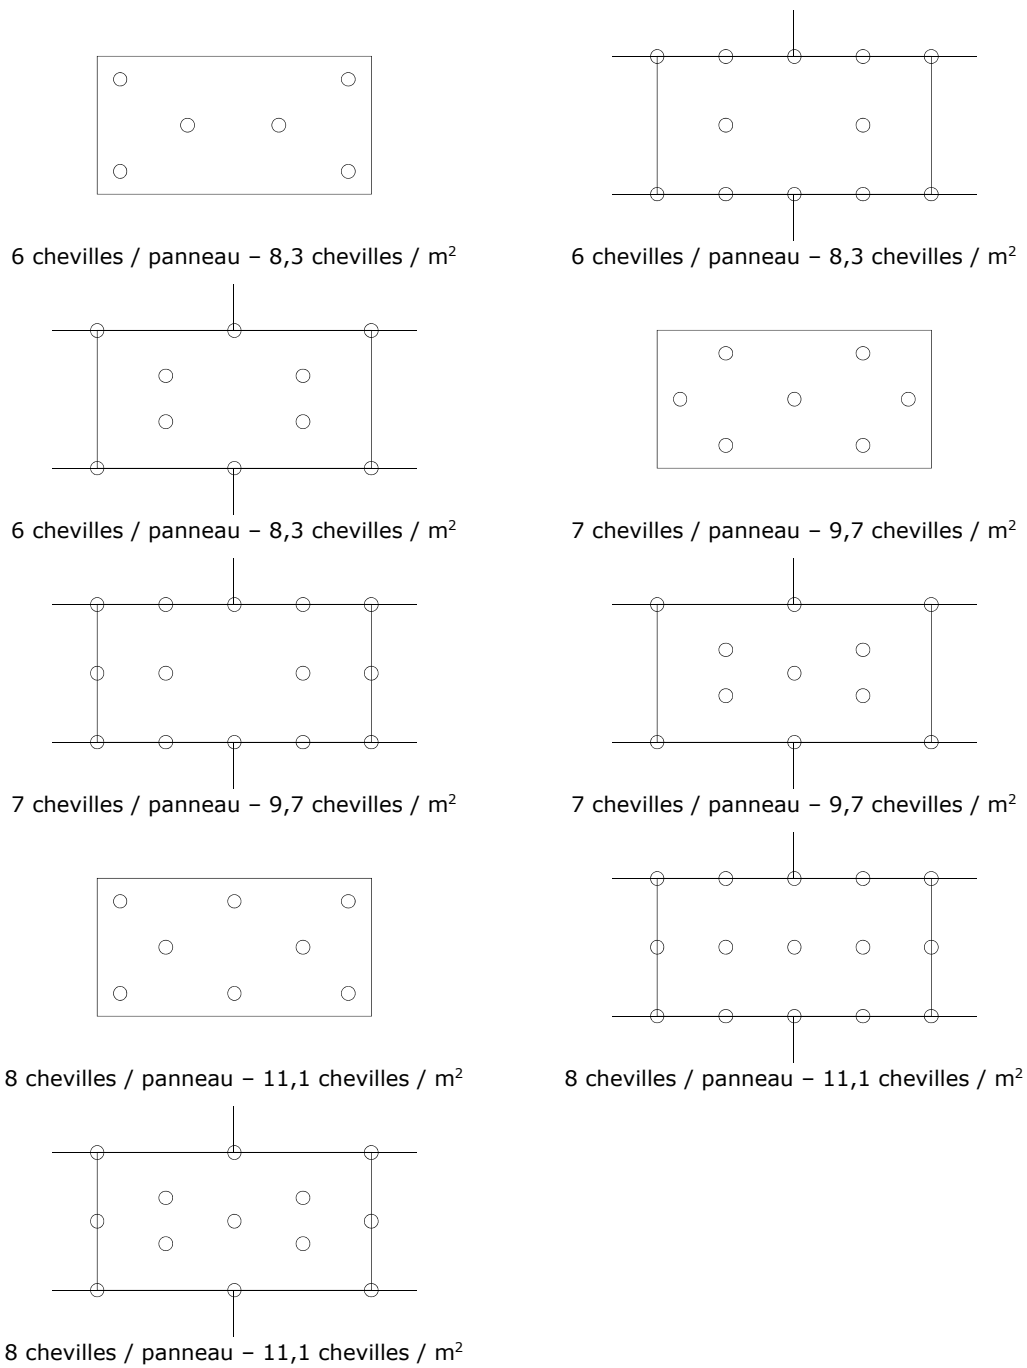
Plans de chevillage - panneaux de dimensions 1200 x 600 mm
